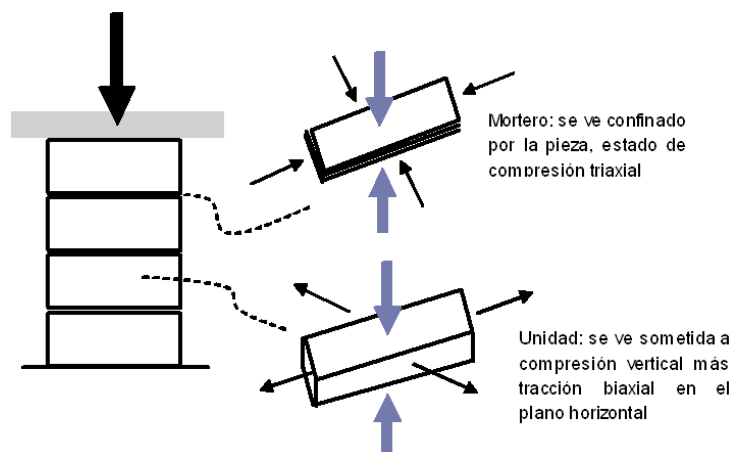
Ensayo a compresión de la fábrica de ladrillo.
